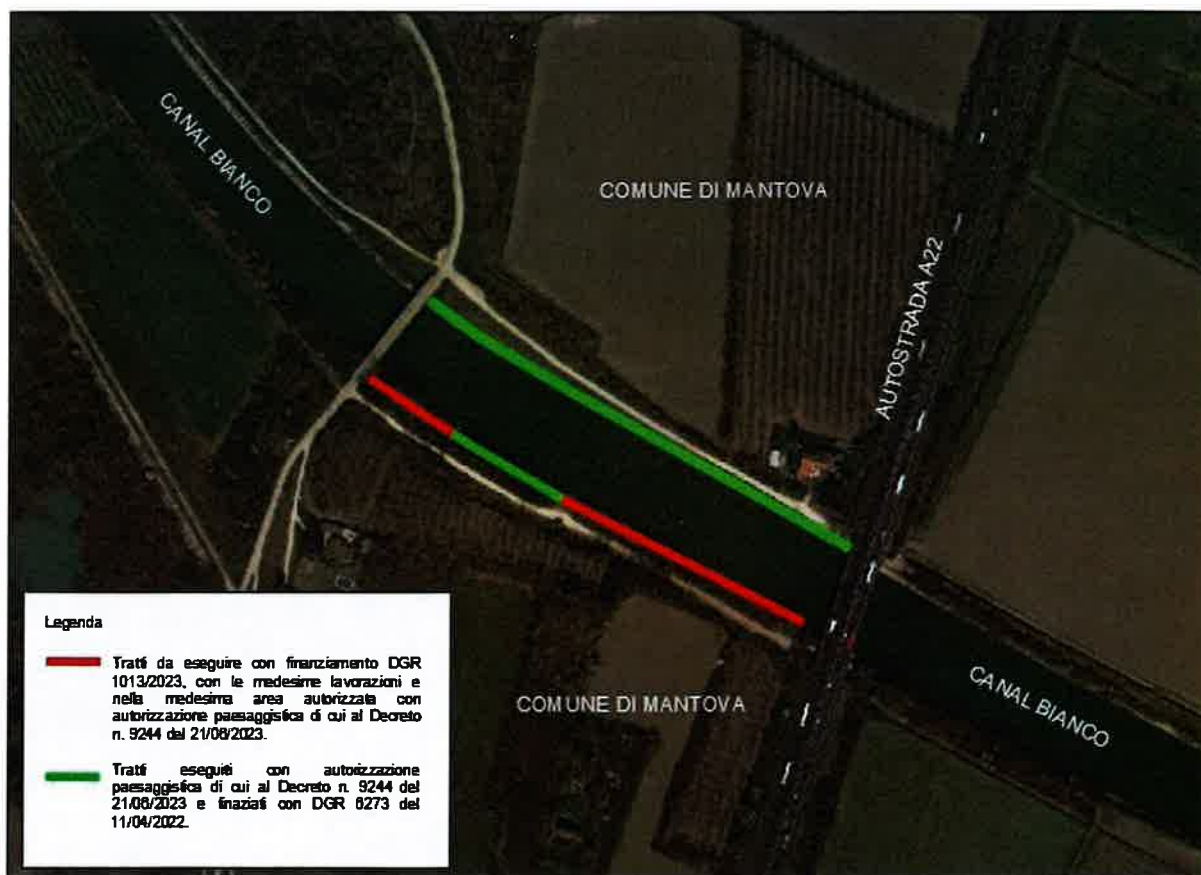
Planimetria con indicazione dei tratti oggetto di medesime lavorazioni eseguite e da eseguire.
